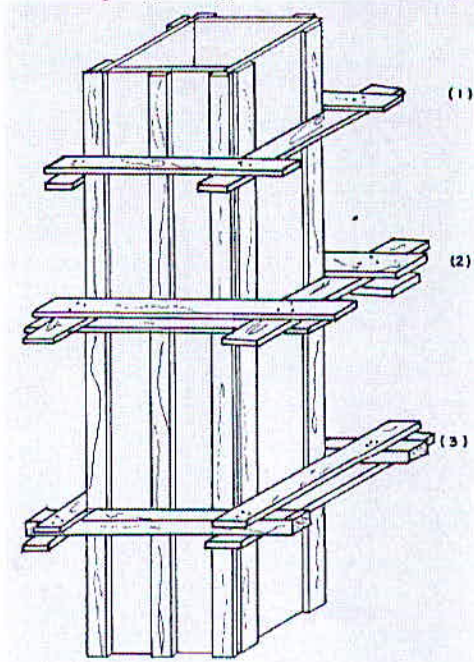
Detalhe do escoramento e contraventamento em pilares, bem como das janelas.
